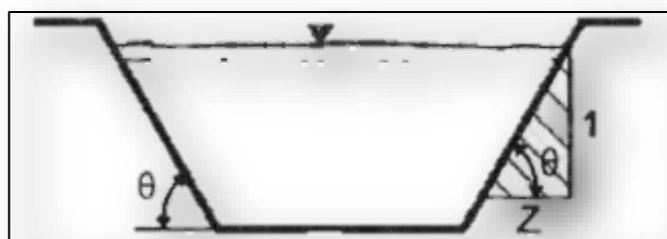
Talud de un Canal Trapezoidal. (Fuente: Villon, (2007)).
